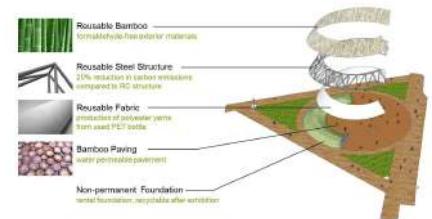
Axonometría constructiva\_J.J. Pan & Partners
